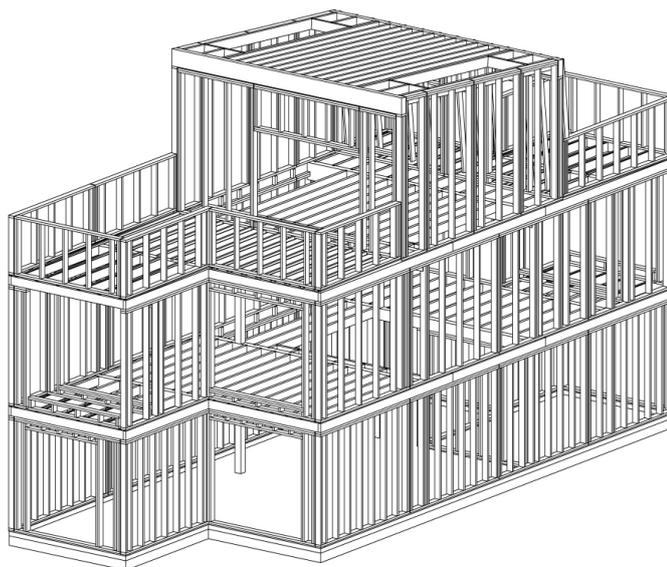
Axonometria da estrutura em madeira da habitação considerada
